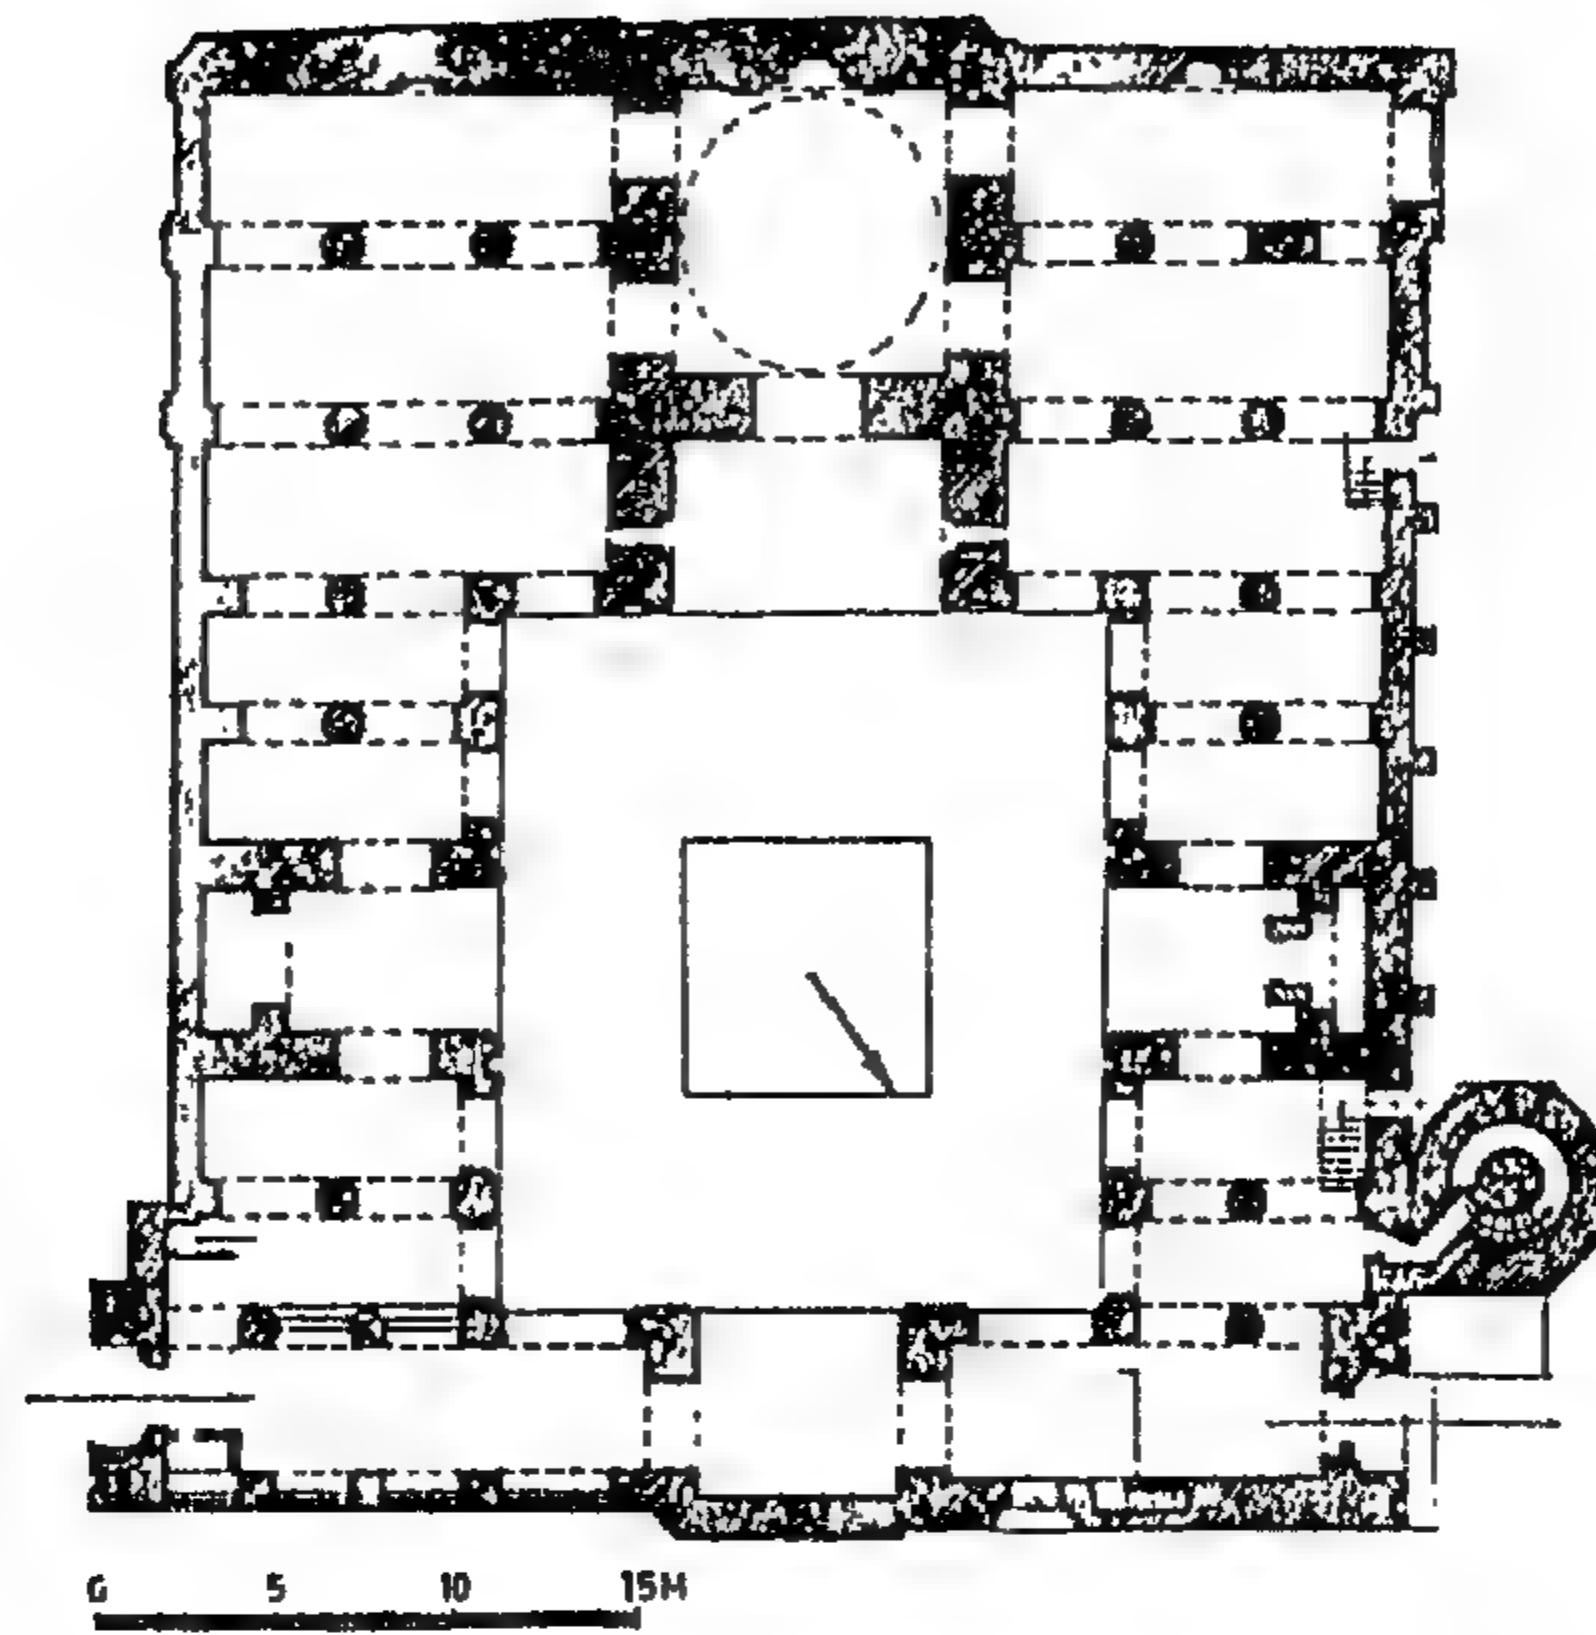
مسقط أفقي للجامع الأزرق في تبريز. (عن : Pope).
